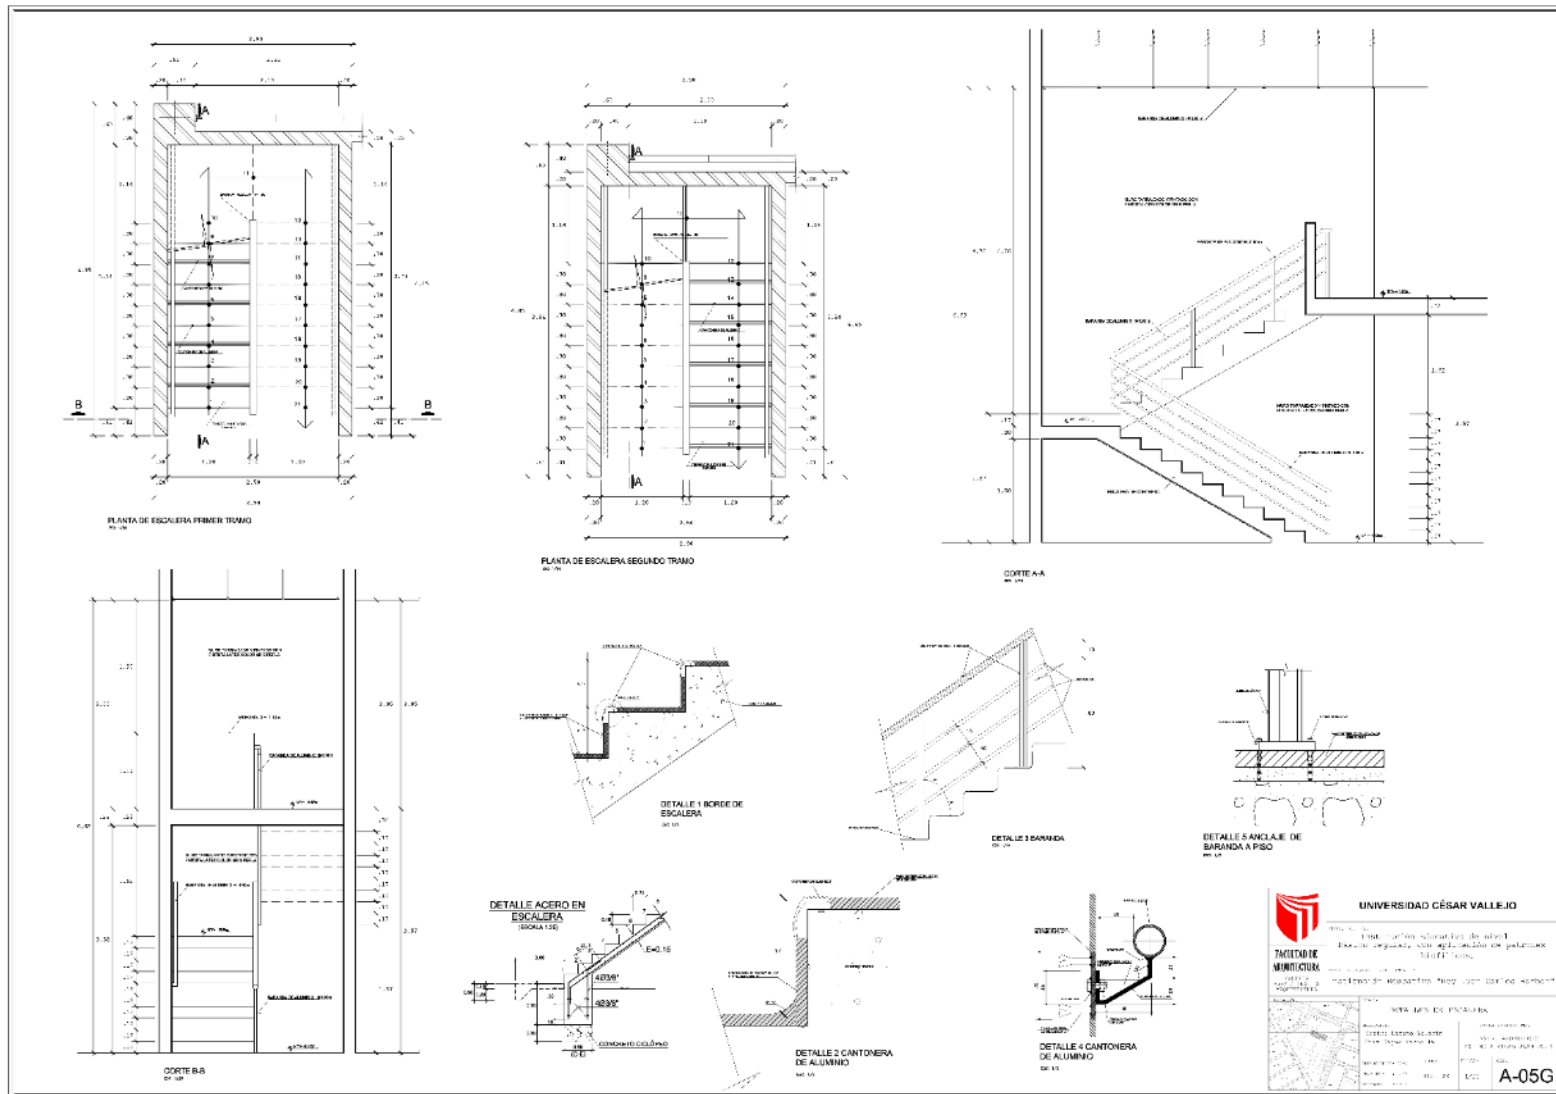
Plano Detalles de escaleras bloque "G", Fuente: elaboración propia
